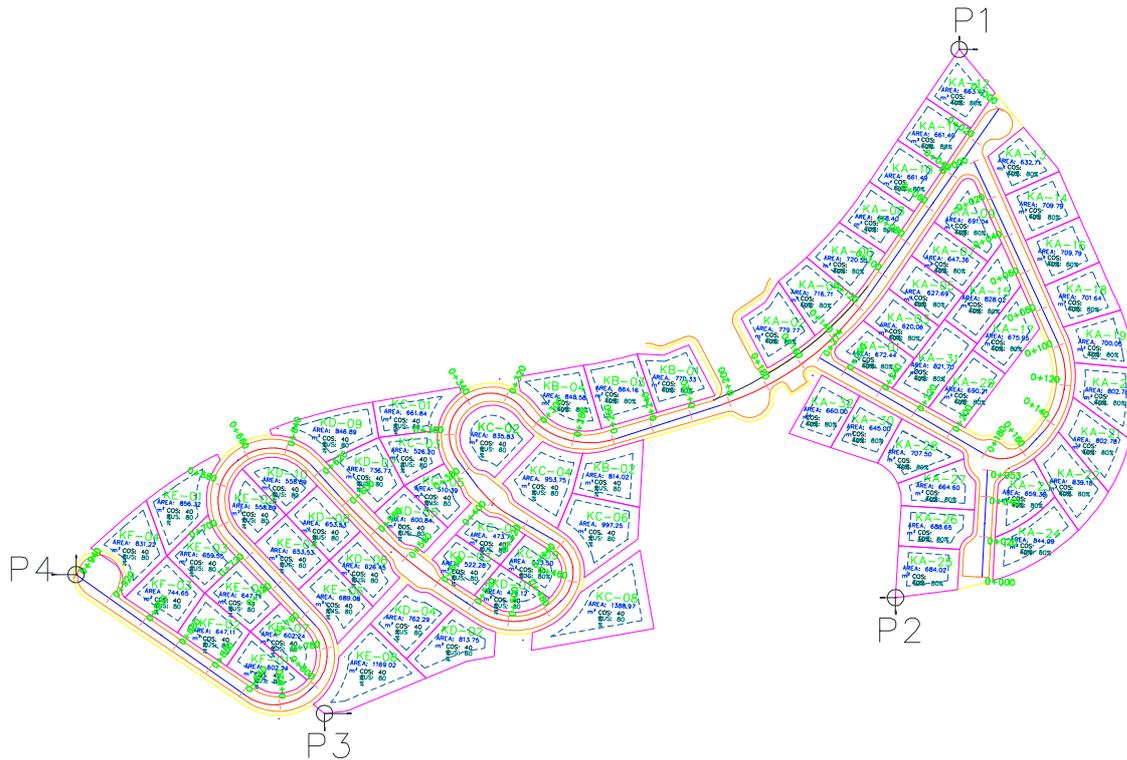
PLANO URBANÍSTICO "COLINAS DE KAPOK"
